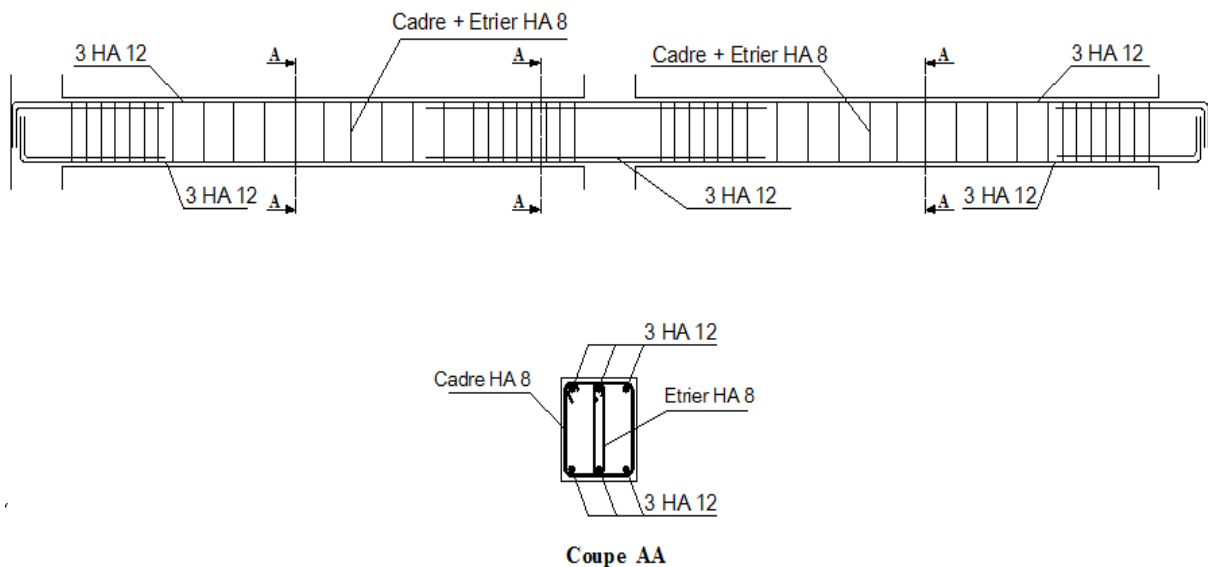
Ferrailage de la poutre de chaînage reposant sur trois appuis.
